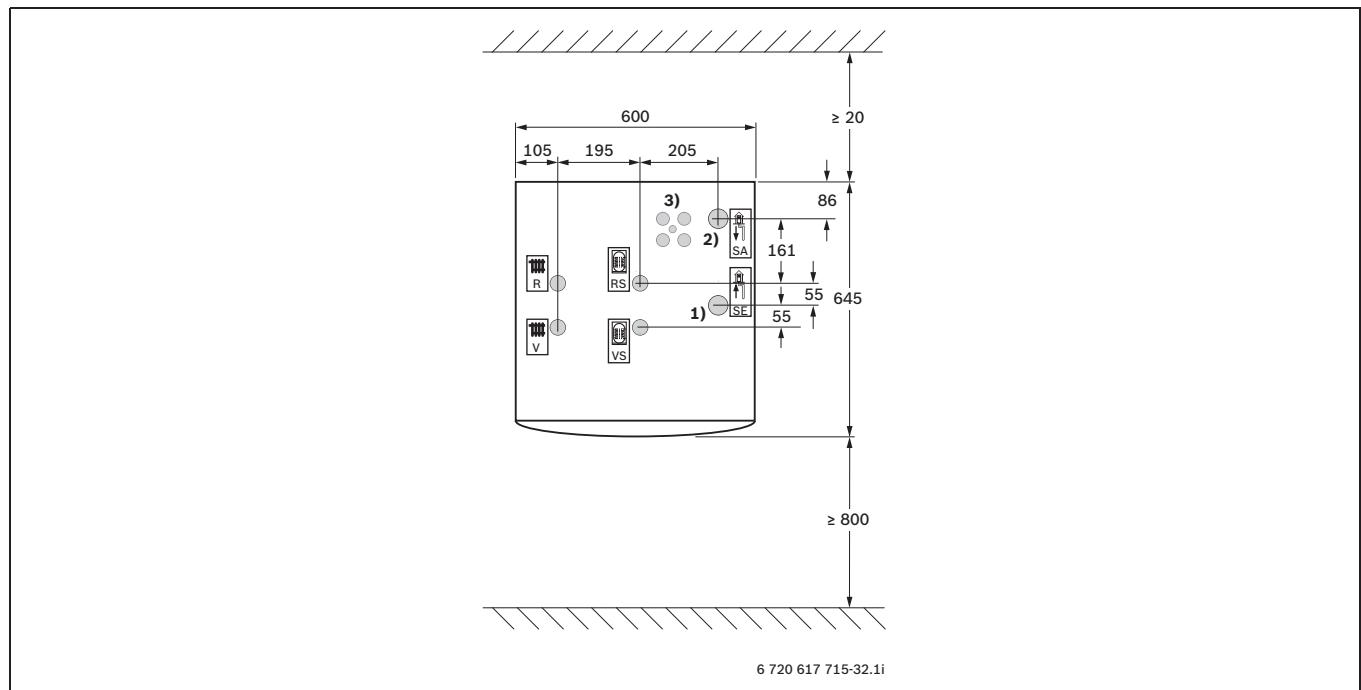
Abmessungen der Wärmepumpen STE 60 ... STE 170 (Maße in mm)
